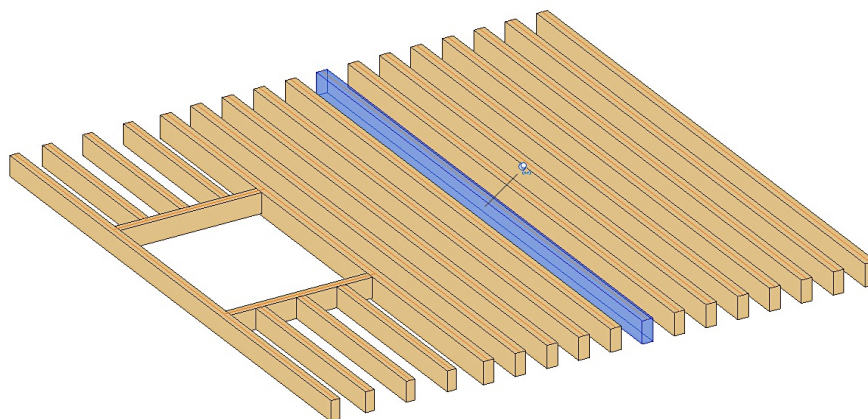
Modelação em Revit do novo pavimento (vigamento) da divisão Norte, lado nascente.
